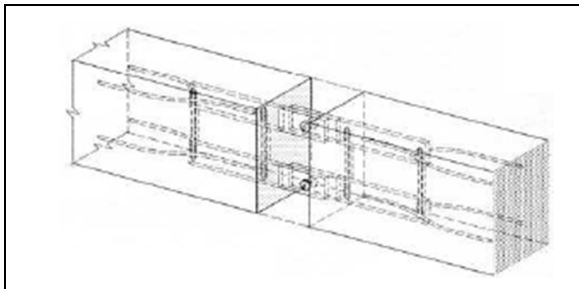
Ligação por chapas metálicas aparafusadas e betonagem *in situ* (Stupré, 1981)
